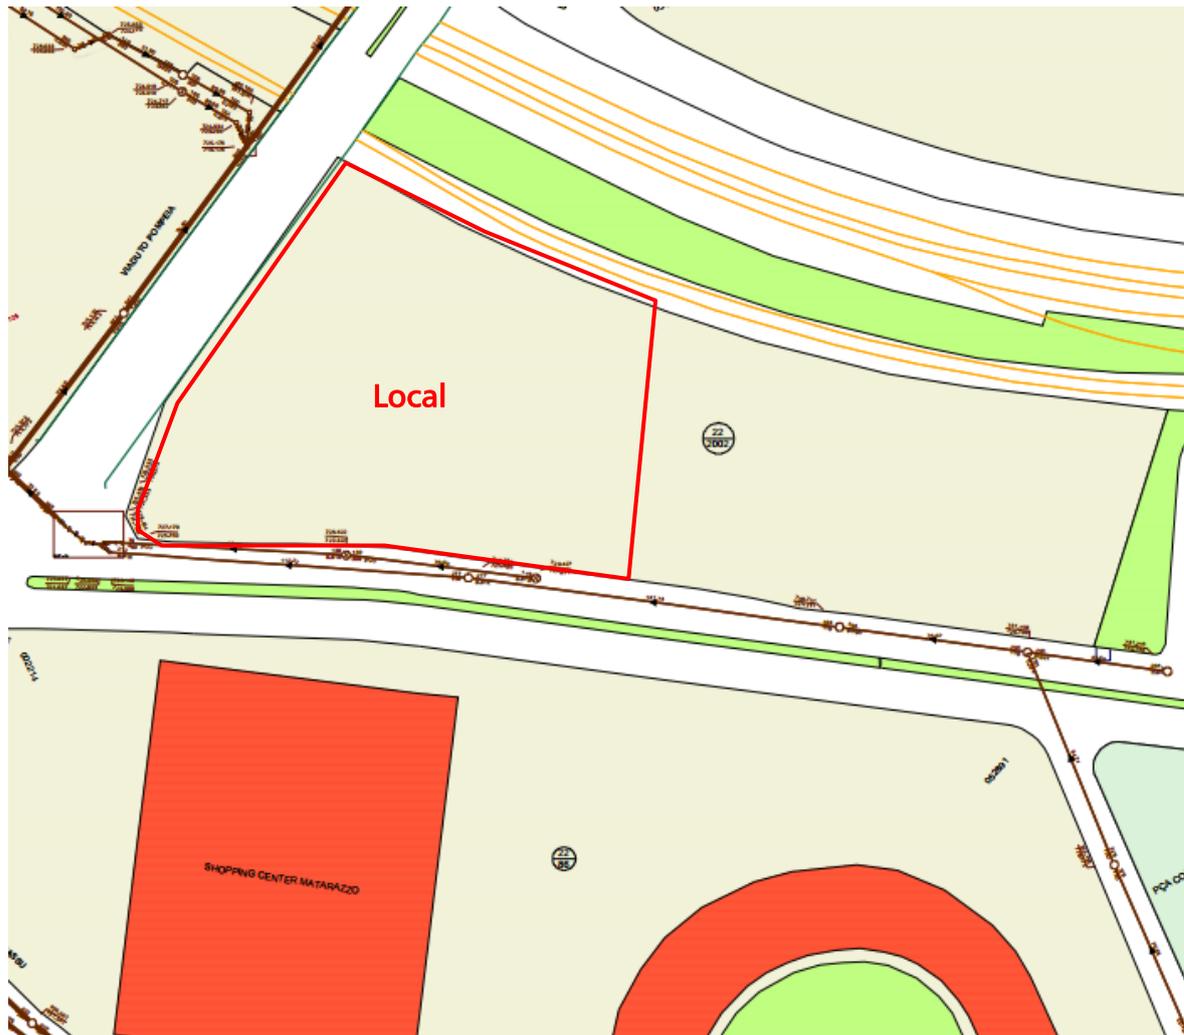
Cadastro da rede de esgoto existente - Fonte: SABESP
